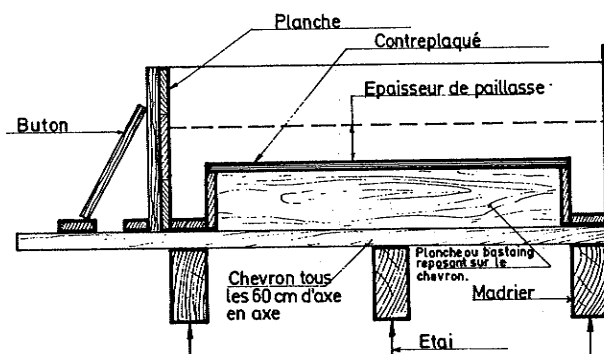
Section transversale : coffrage d'un escalier avec limons inférieurs.
